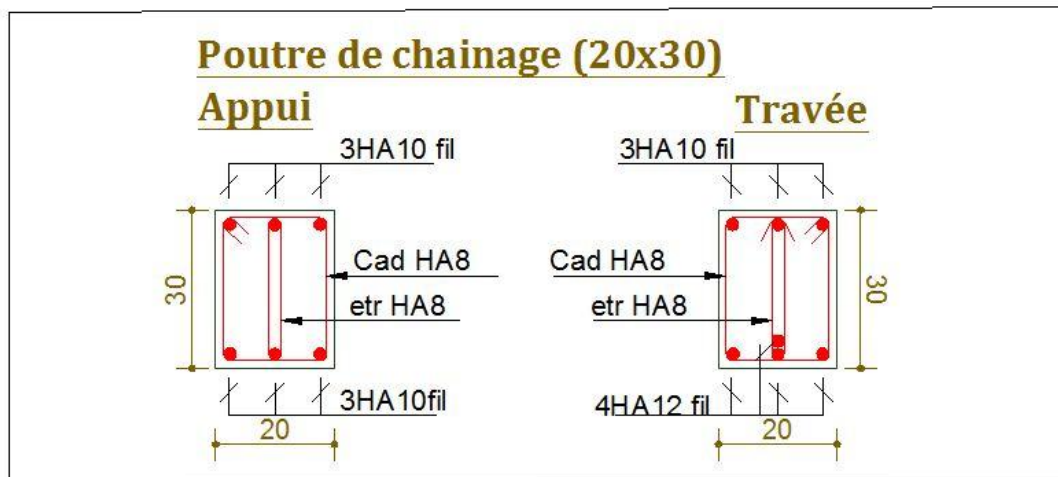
Schéma de ferrailage de la poutre de chaînage.
